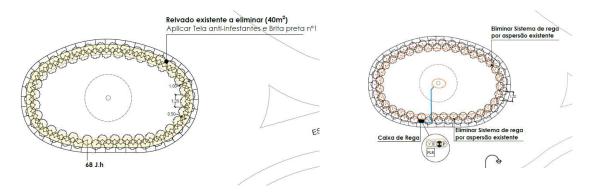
Imagens do Plano de Plantação e de Rega na rotunda Dunamar.
